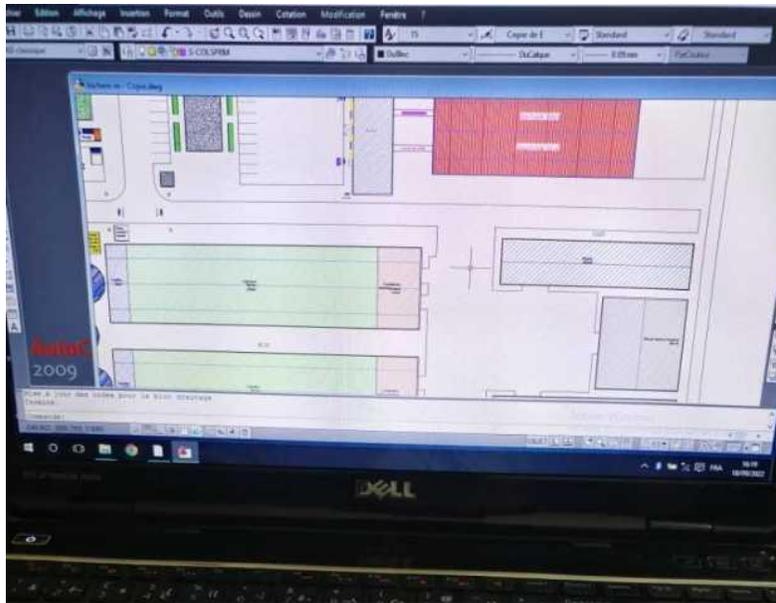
la réalisation du plan architectural de notre ferme par l'AutoCAD.
